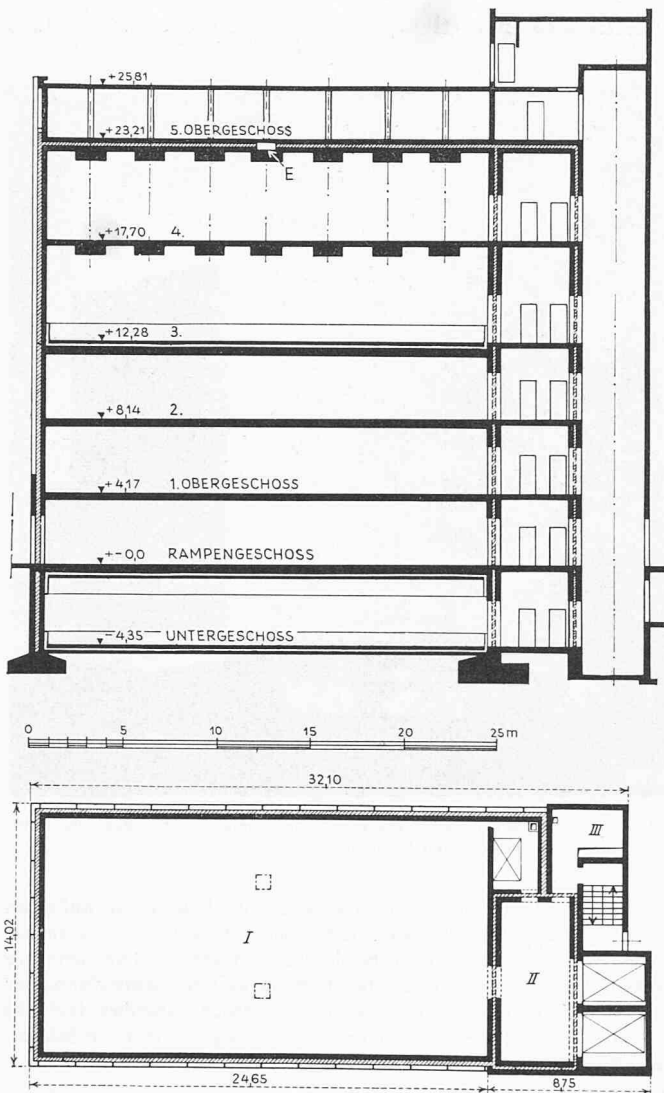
Längsschnitt durch das neue Kühlhaus und Grundriss des dritten Obergeschosses mit den drei Temperaturzonen, 1:400. E = Eichenholzklotz, auch im Grundriss angedeutet
